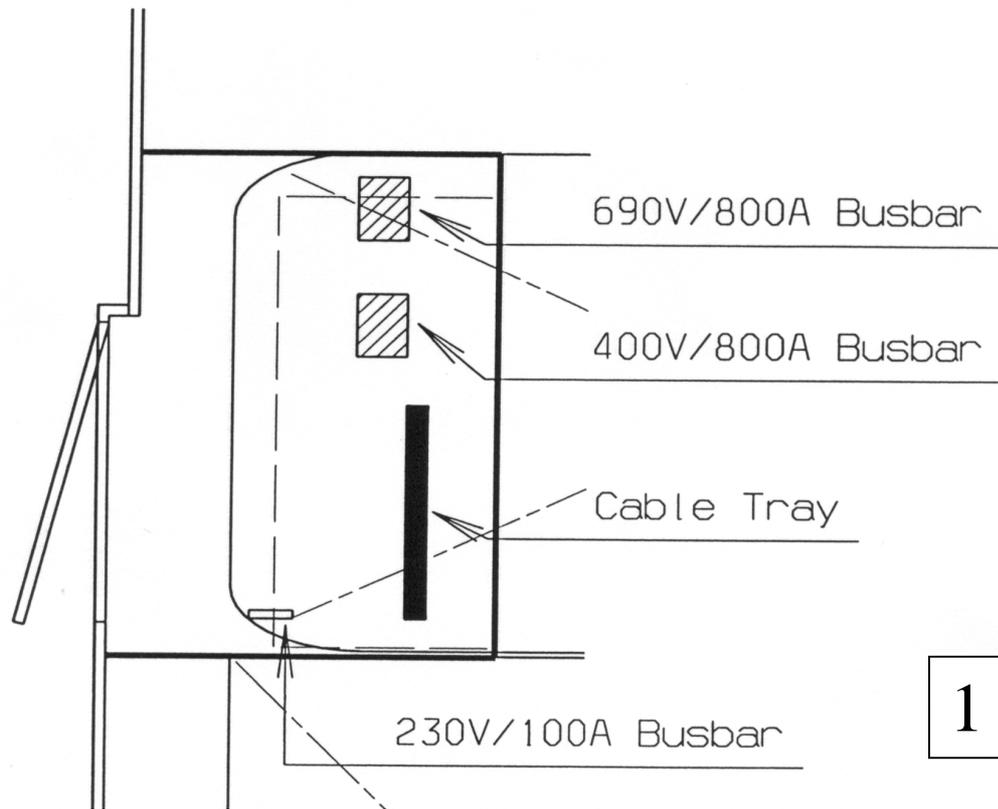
Detailzeichnung Steigleitungsschacht Backbordseite
